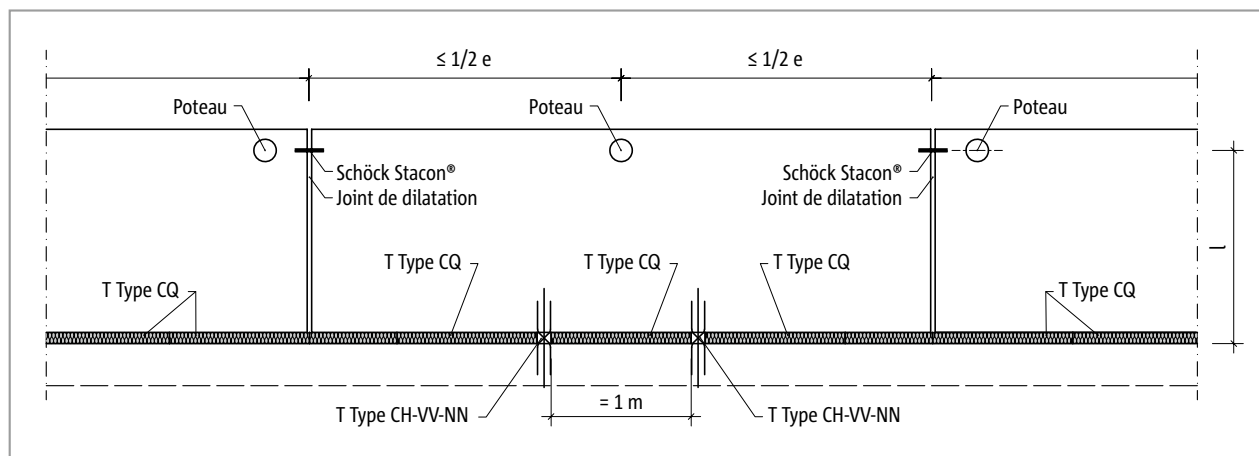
Schöck Isokorb® T Type CH : disposition du joint de dilatation
